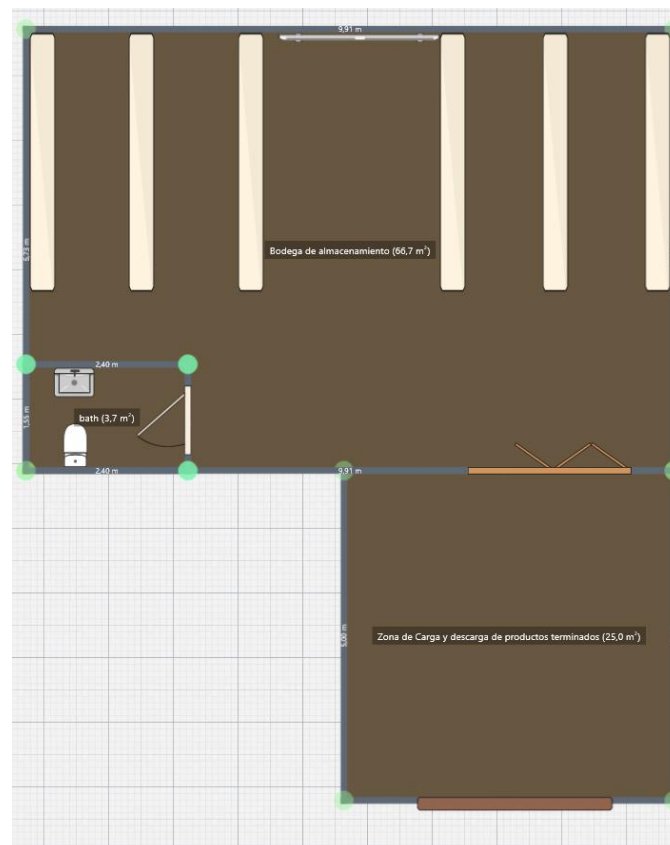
Levantamiento de planos bodega RÍO ROJO
